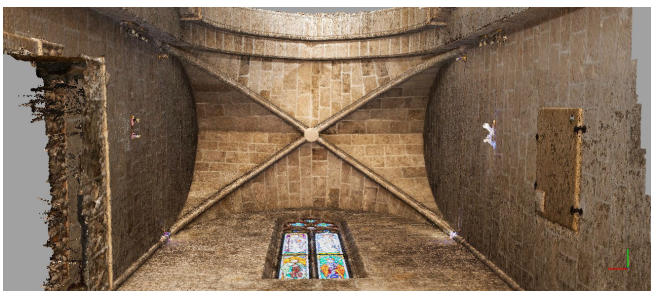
Vistas modelo 3D plementería realizadas con PhotoScan.
